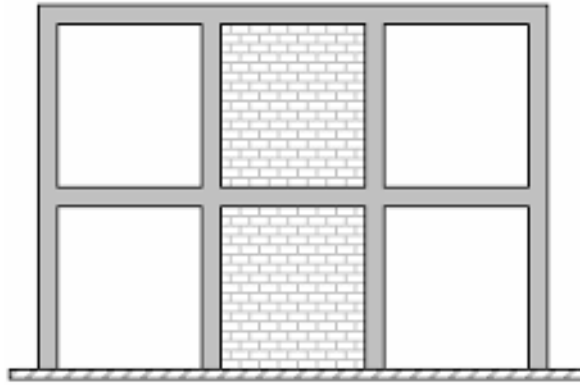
Sistema Estructural: Pórticos de hormigón armado con mampostería confinada sin refuerzo
